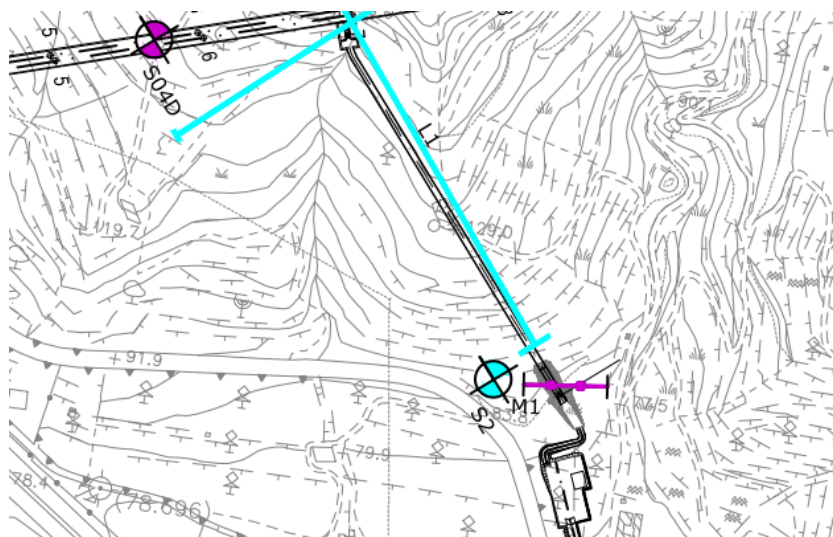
Planimetria con ubicazione del sondaggio S2.
